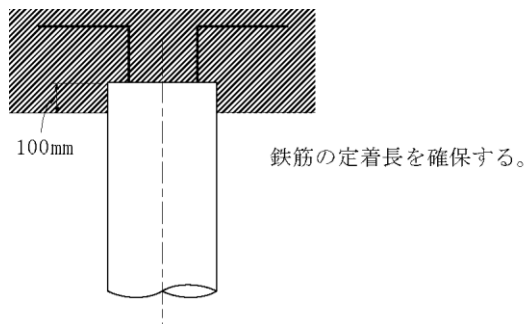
剛結合に準じた標準的な杭頭処理方法
